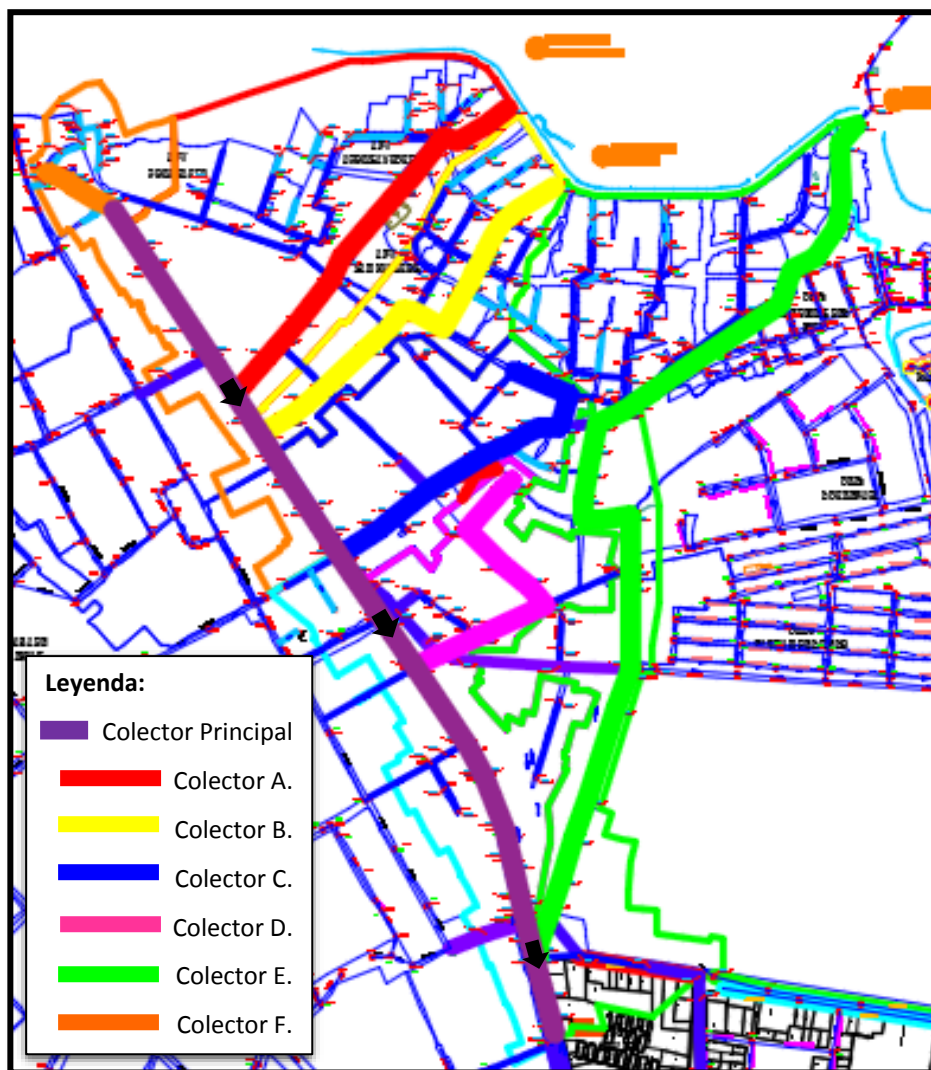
Plano de la propuesta del sistema de alcantarillado pluvial.
